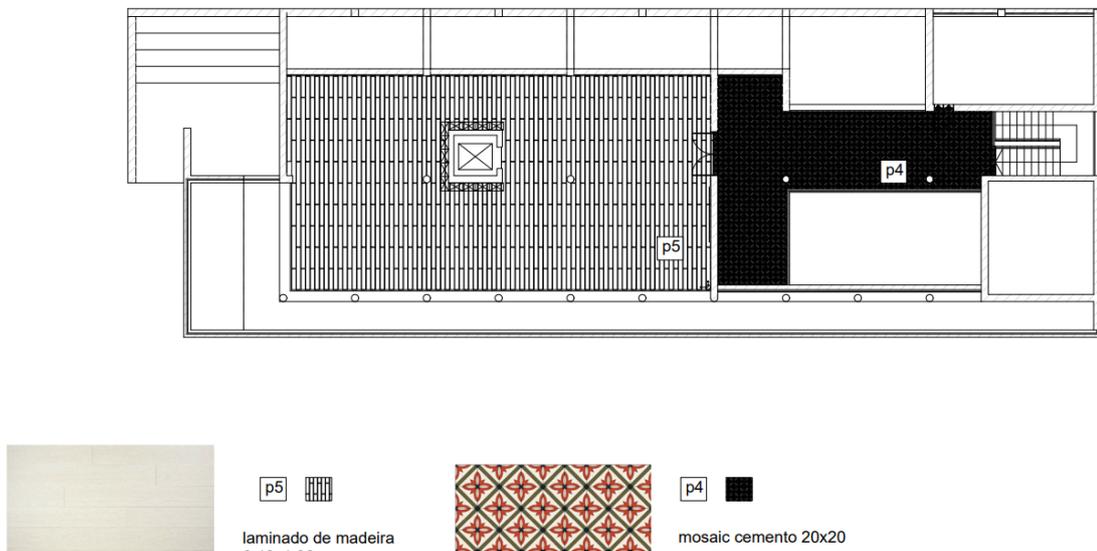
Planta de pavimentos piso 1 Fonte: Catarina Almeida Moita
